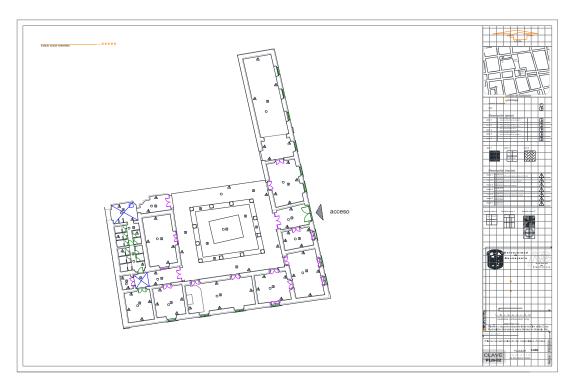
Plano levantamiento de materiales pisos. Eloísa Galván González. 2016.
